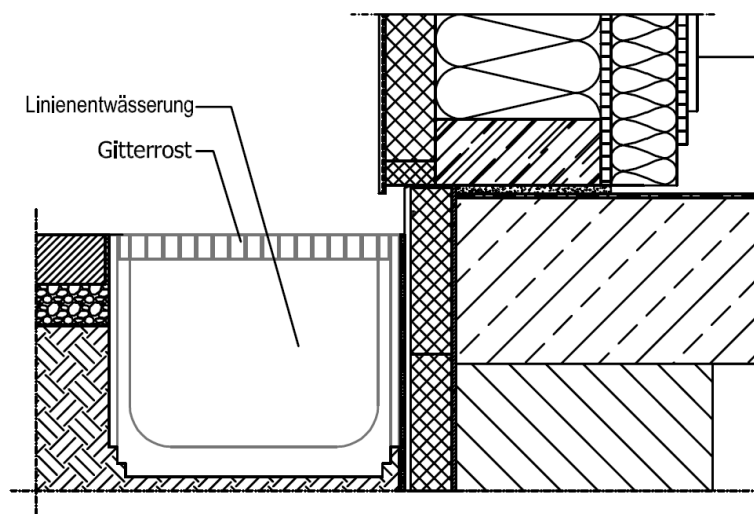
Linienentwässerung mit Gitterrost vor der LUXHAUS Fassade (schematische Darstellung)
